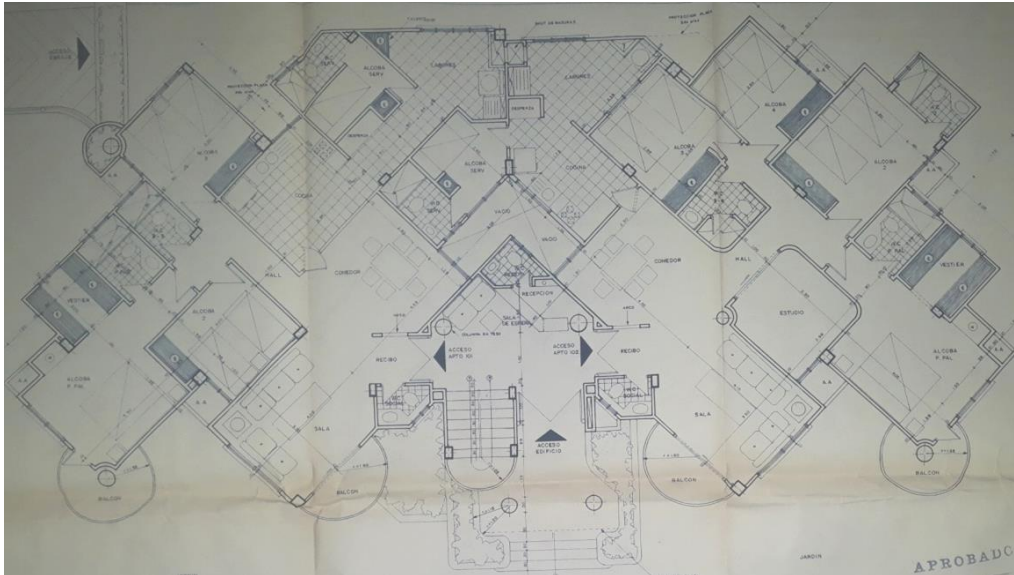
Planta arquitectónica 1 piso Ed. Altos de Venecia (1995).
